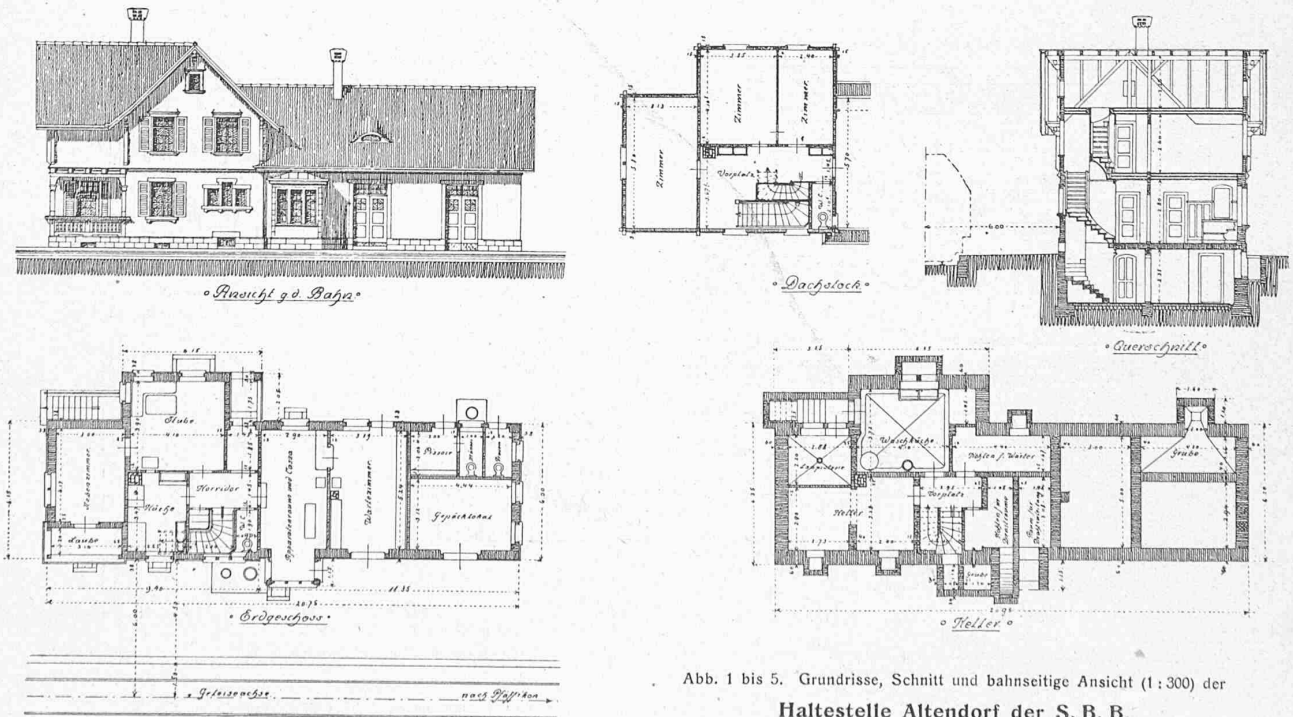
bis 5. Grundrisse, Schnitt und bahnseitige Ansicht (1 : 300) der Haltestelle Altendorf der S. B. B.
